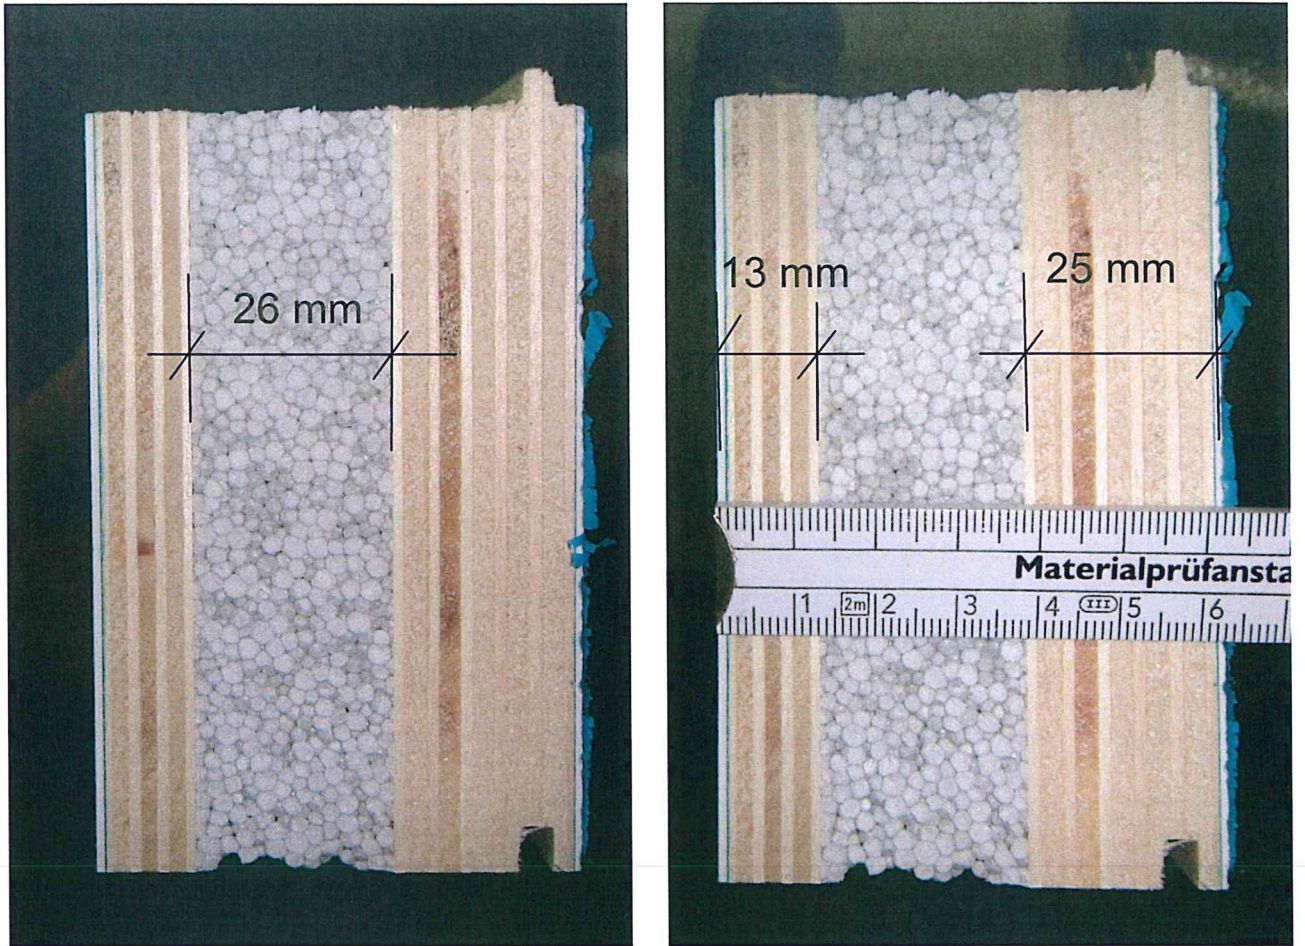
Ansicht und Detail blaugelb Sockeldämmprofilen (PVC/EPS), $d_{\text{Profil}} = 64 \text{ mm}$
